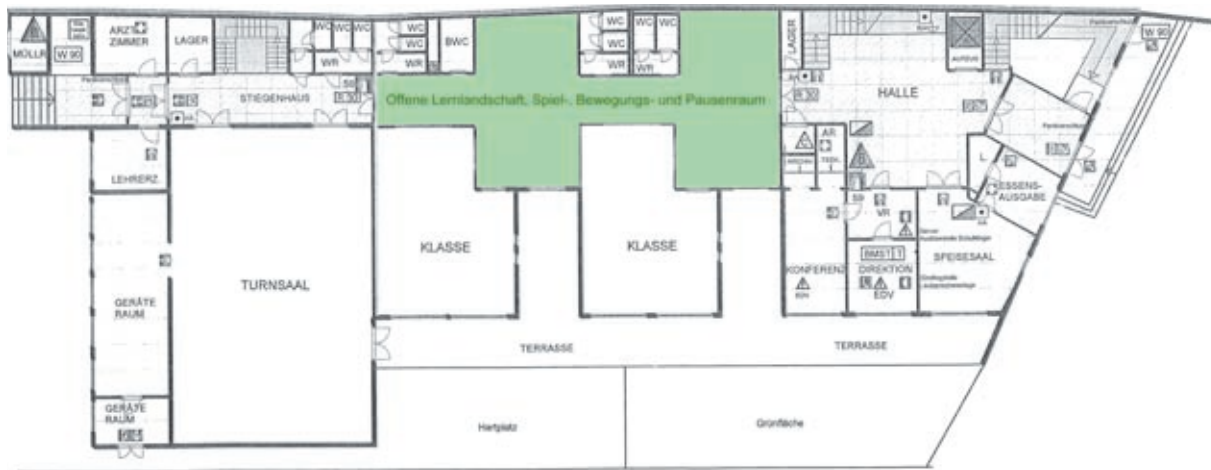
Plan Grundriss Erdgeschoß
